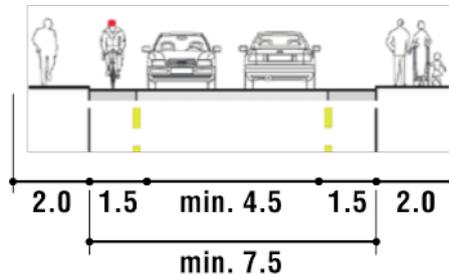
Profil-type d'une chaussée à voie centrale banalisée
